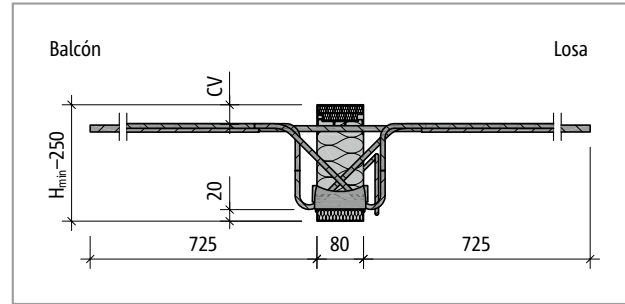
Schöck Isokorb® T tipo K-M6-VV1: Sección del producto
